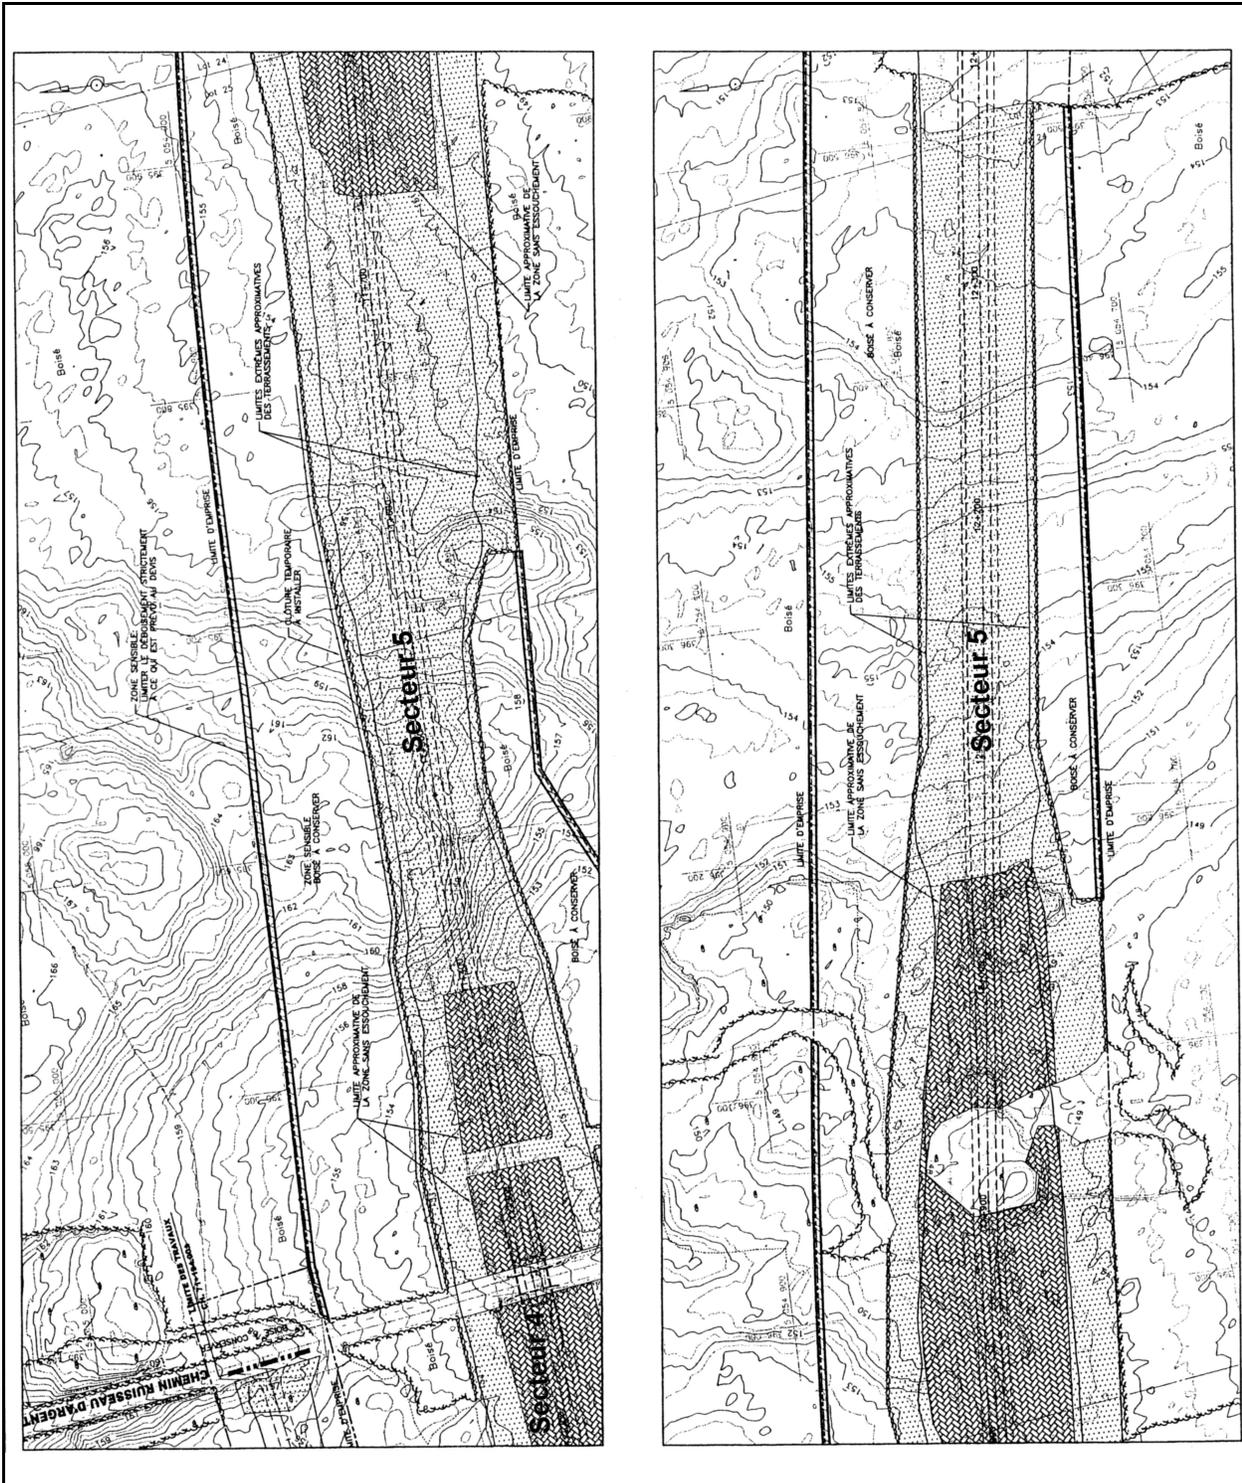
Localisation des secteurs d'inventaire sur le plan de construction du projet 20-6671-9509, autoroute 50 (6/8)
